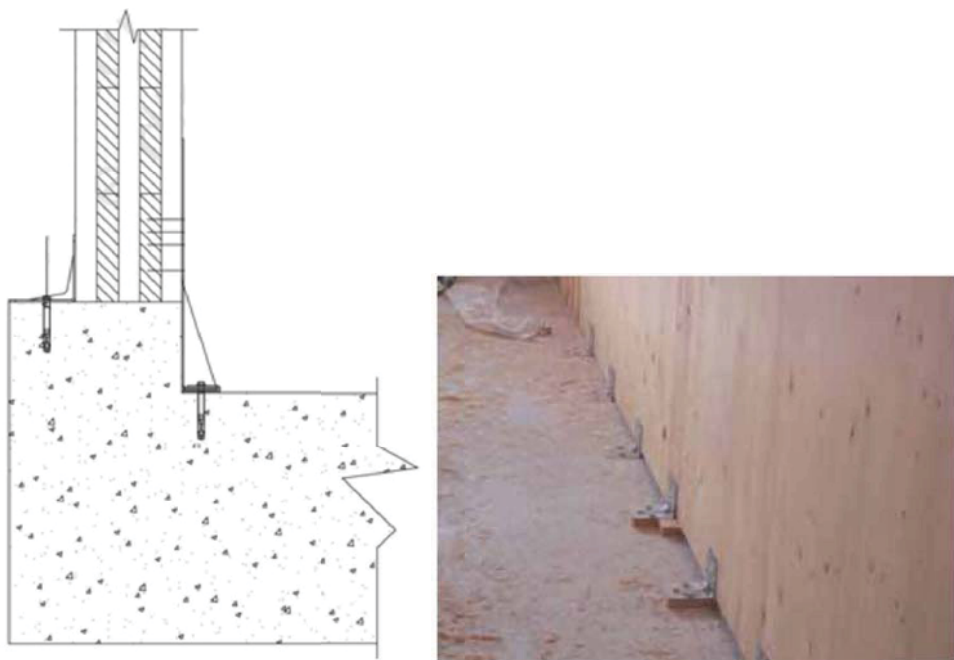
Sistema meccanico di collegamento tra pannelli X-LAM e trave di fondazione prefabbricata in cemento armato.¹⁰
